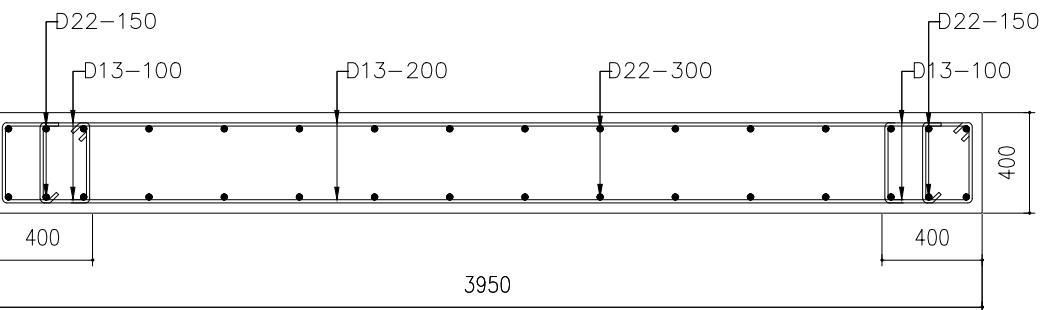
DETAIL COREWALL TYPE CW-1A LANTAI P1 S/D P7
